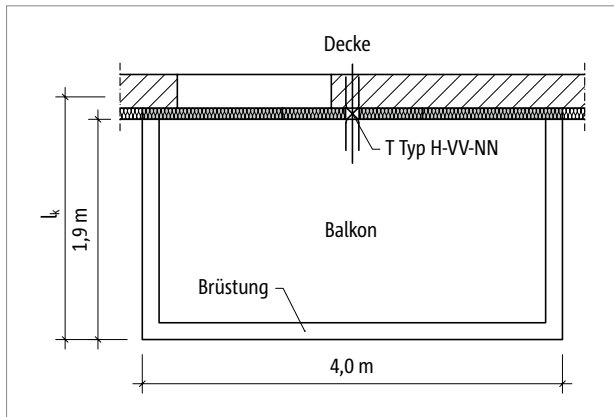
Schöck Isokorb® T Typ K, H: Grundriss
